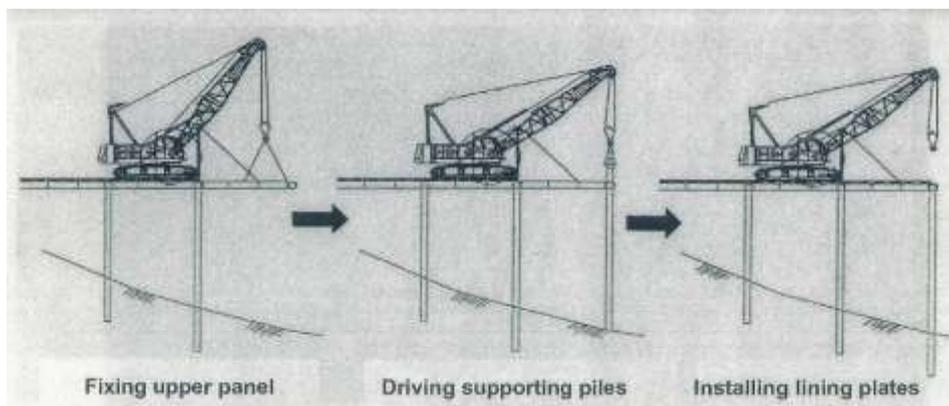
施工棧道採斜張式架設工法之施工步驟示意圖
